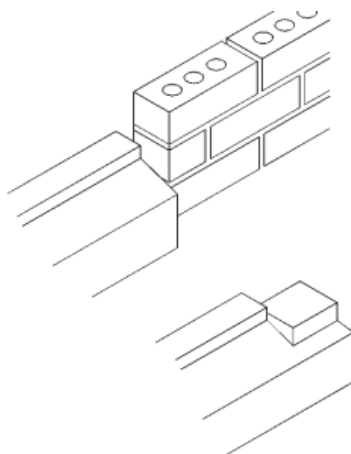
O perfil longitudinal do parapeito tem influência na estanquidade da fachada [18]
